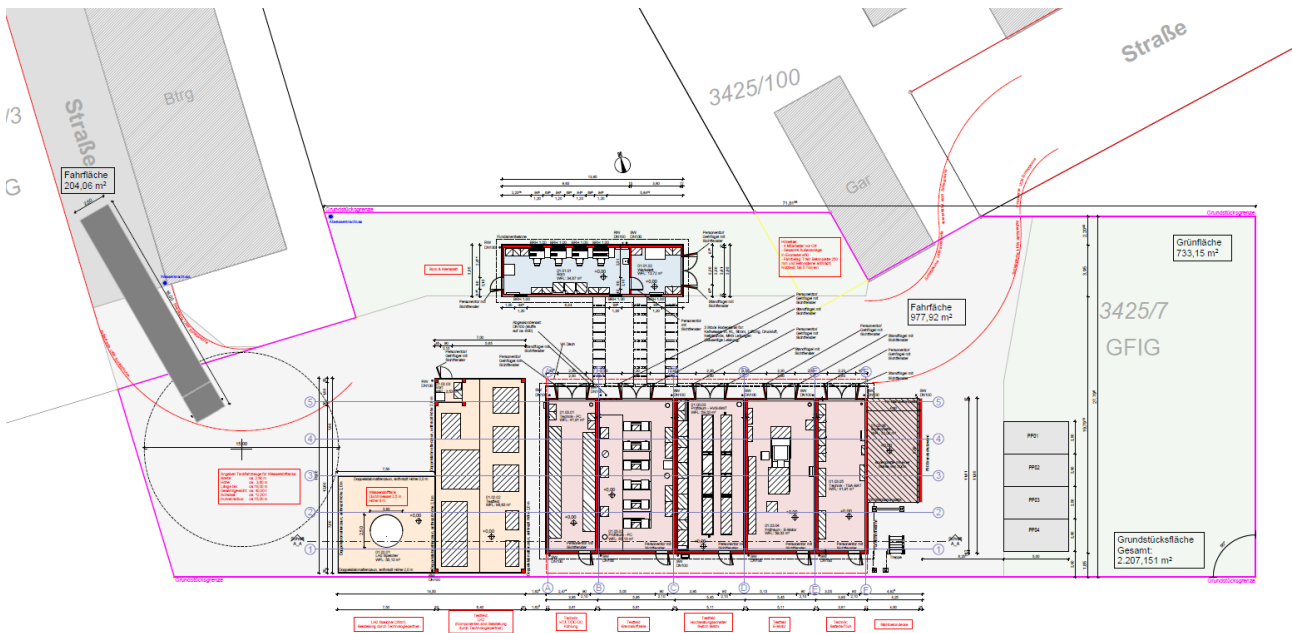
Grundriss / Lageplan BALIS
